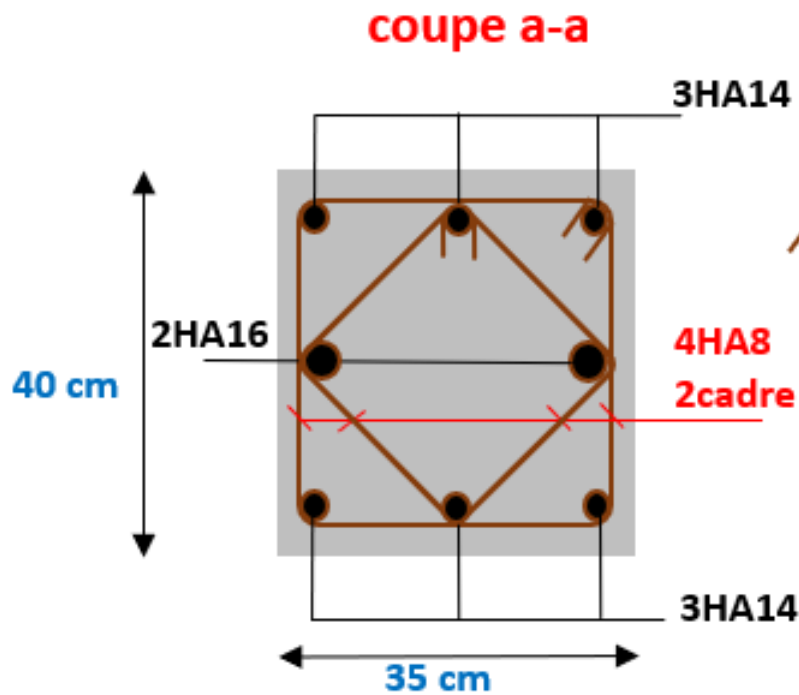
poteau 35*40cm (coupe a-a)
